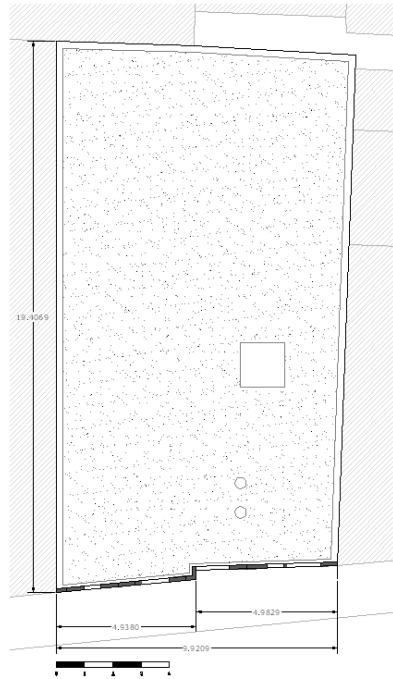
Planta Cobertura, Escala 1/100, Autocad
